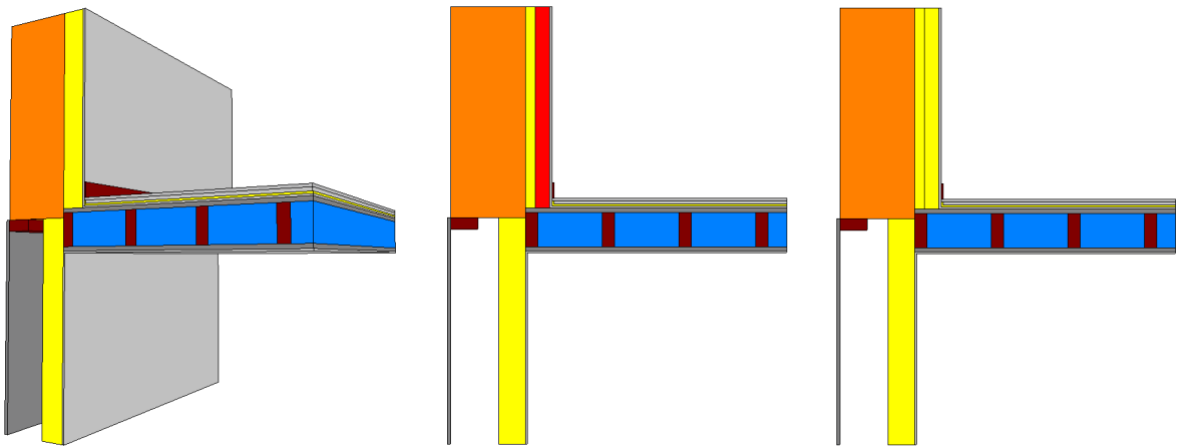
Trisco : vue 3D du modèle de la rencontre d'un plancher en bois, d'un mur de façade isolé par l'intérieur et d'un ancien caisson à volet rempli d'isolant.
